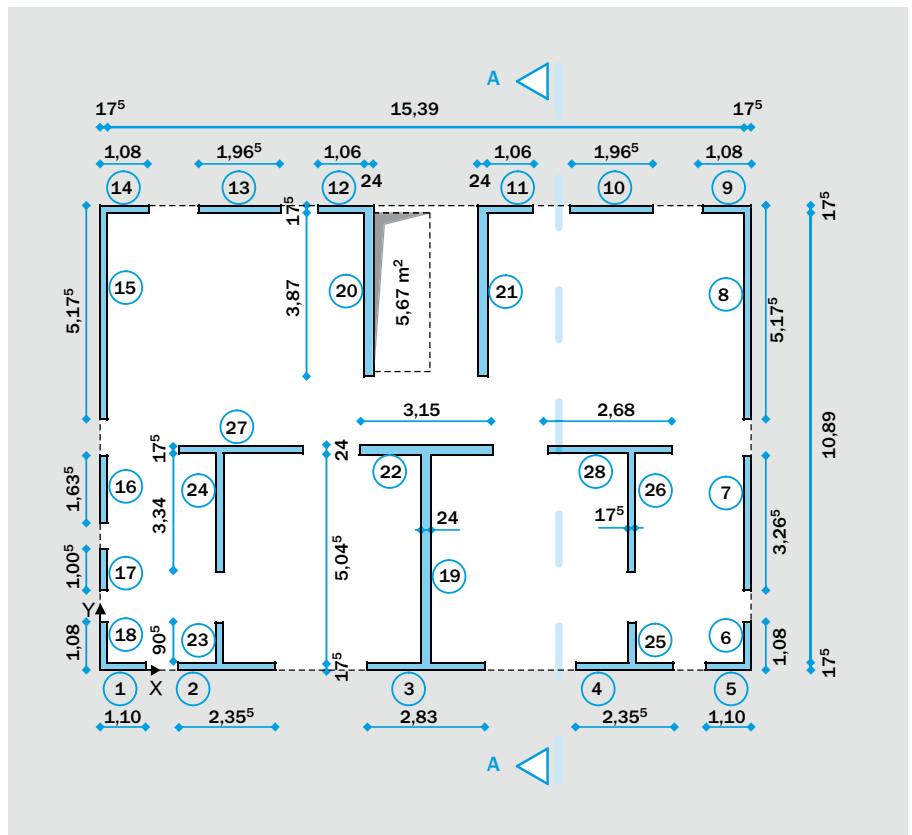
Grundriss des Mehrfamilienhauses
